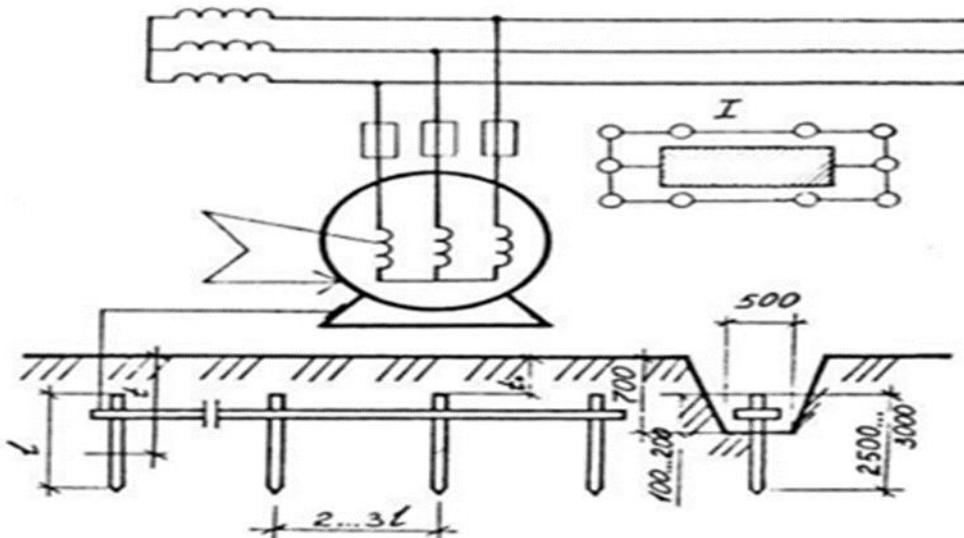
Схема заземляющего устройства: I – расположение заземлителей в плане
